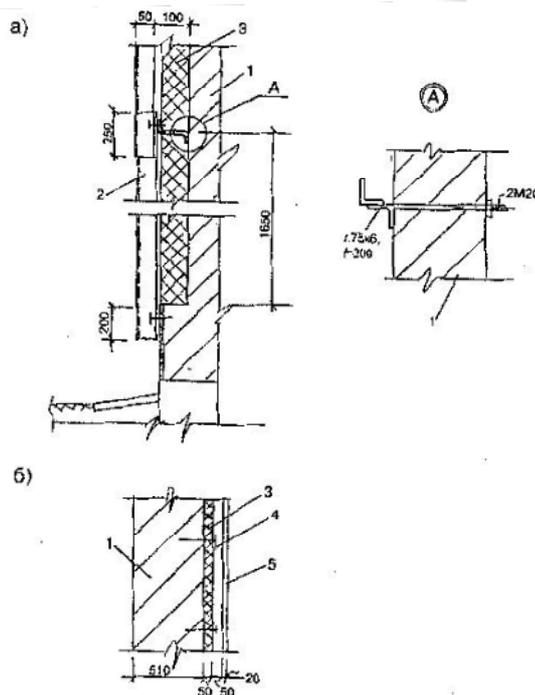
Конструкции стен: а - для зданий с повышенной влажностью; б - утепление существующих стен; 1 - существующая или проектируемая стена; 2 - гофрированная стальная облицовка; 3 утеплитель (полутвёрдые минераловатные плиты); 4 - воздушный вентилируемый зазор; 5 - стальные панели толщиной 0,5 мм по стальным вертикальным направляющим
